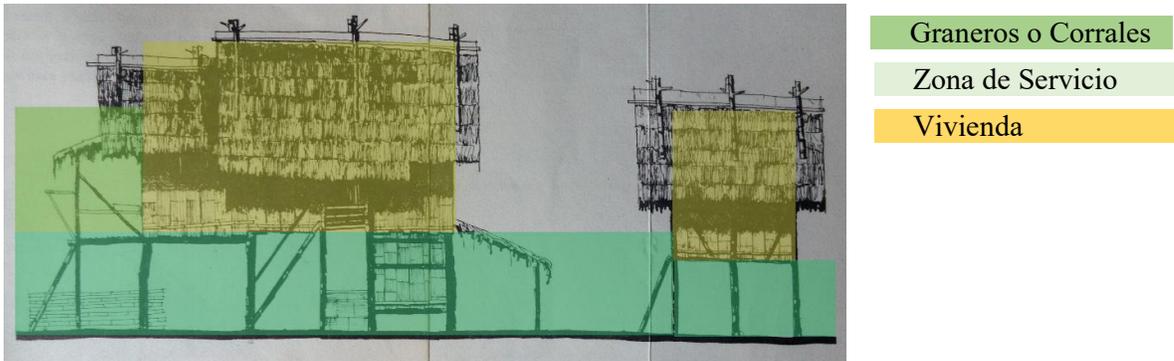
Planta Alta – Zonificación Rancho de Jacinto Ortiz
